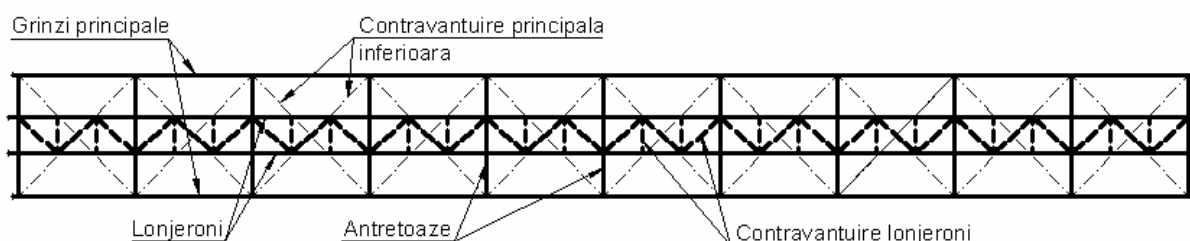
Schema în plan a unui pod metalic cu grinzi cu inimă plină
